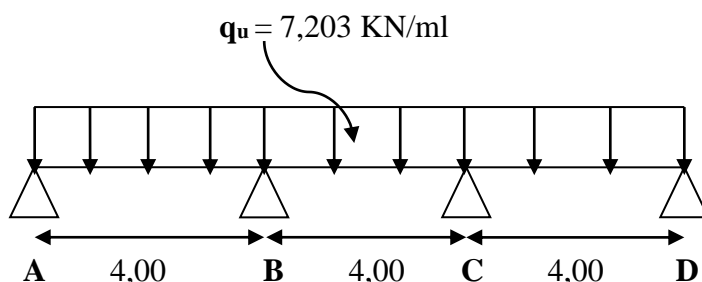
Schéma statique de la poutre continue reposant sur 3 appuis.
